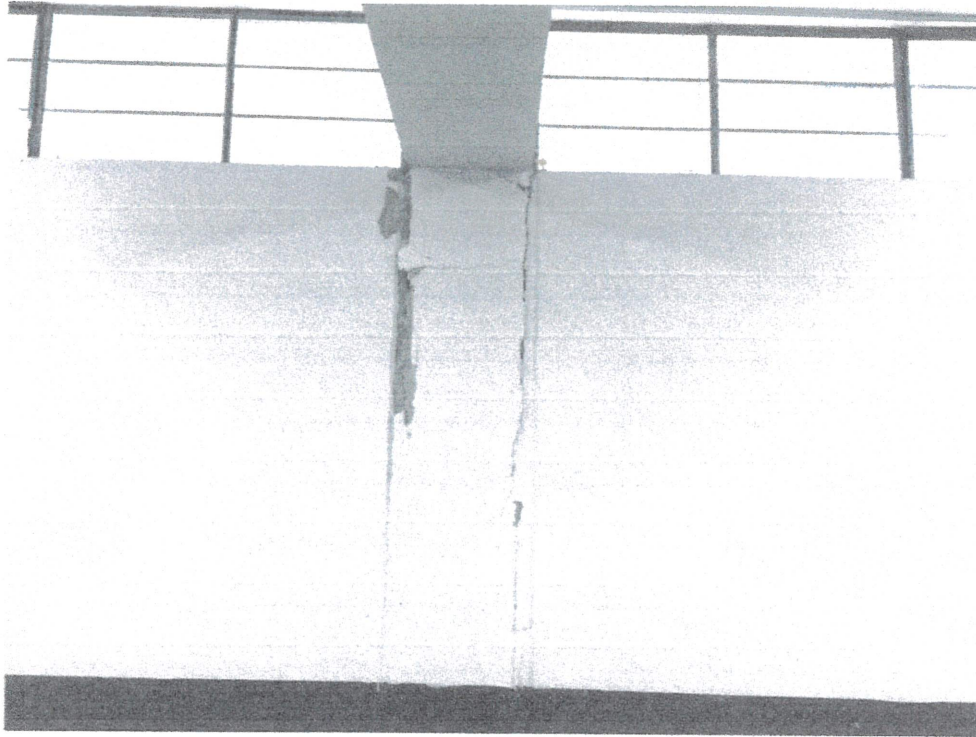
Falla en las juntas de construcción en los muros con la columna, no existe adecuada separación de la junta de los muros con las columnas.
